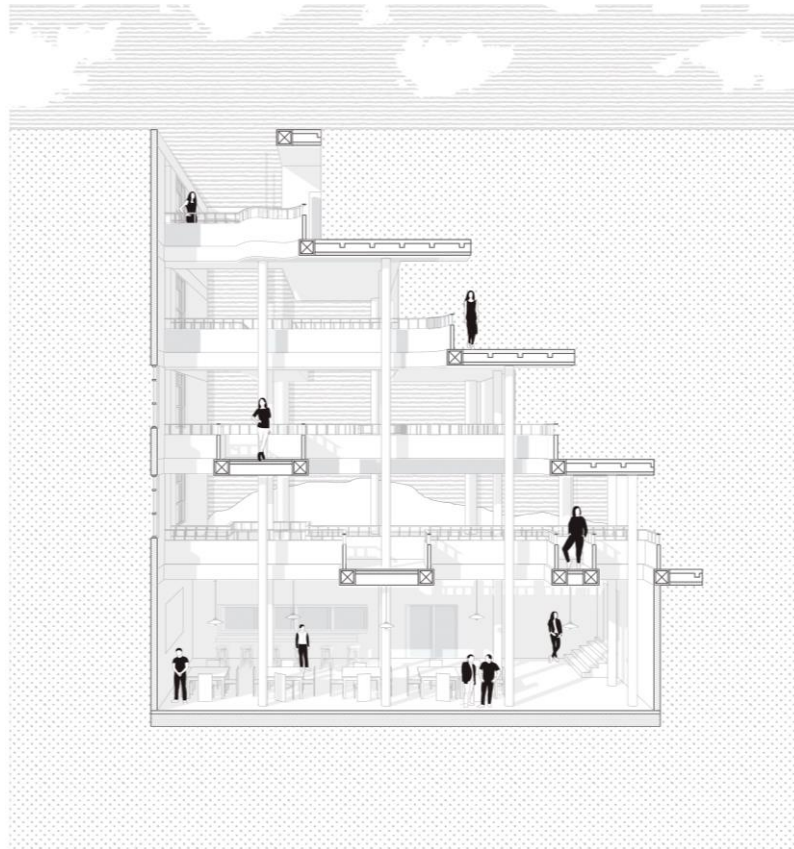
Corte pizzería. Ampliación. Elaboración propia
